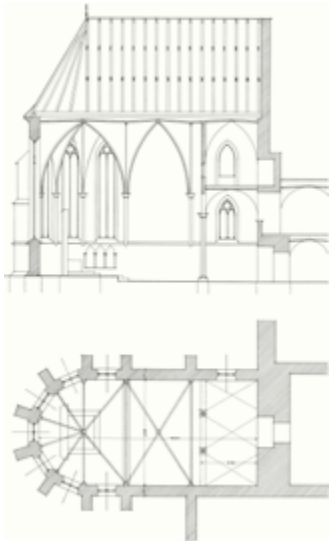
Rekonstruktion der ehem. „Liechtenstein-Kapelle“ im Stift Seckau, Aufrisschnitt und Grundriss
